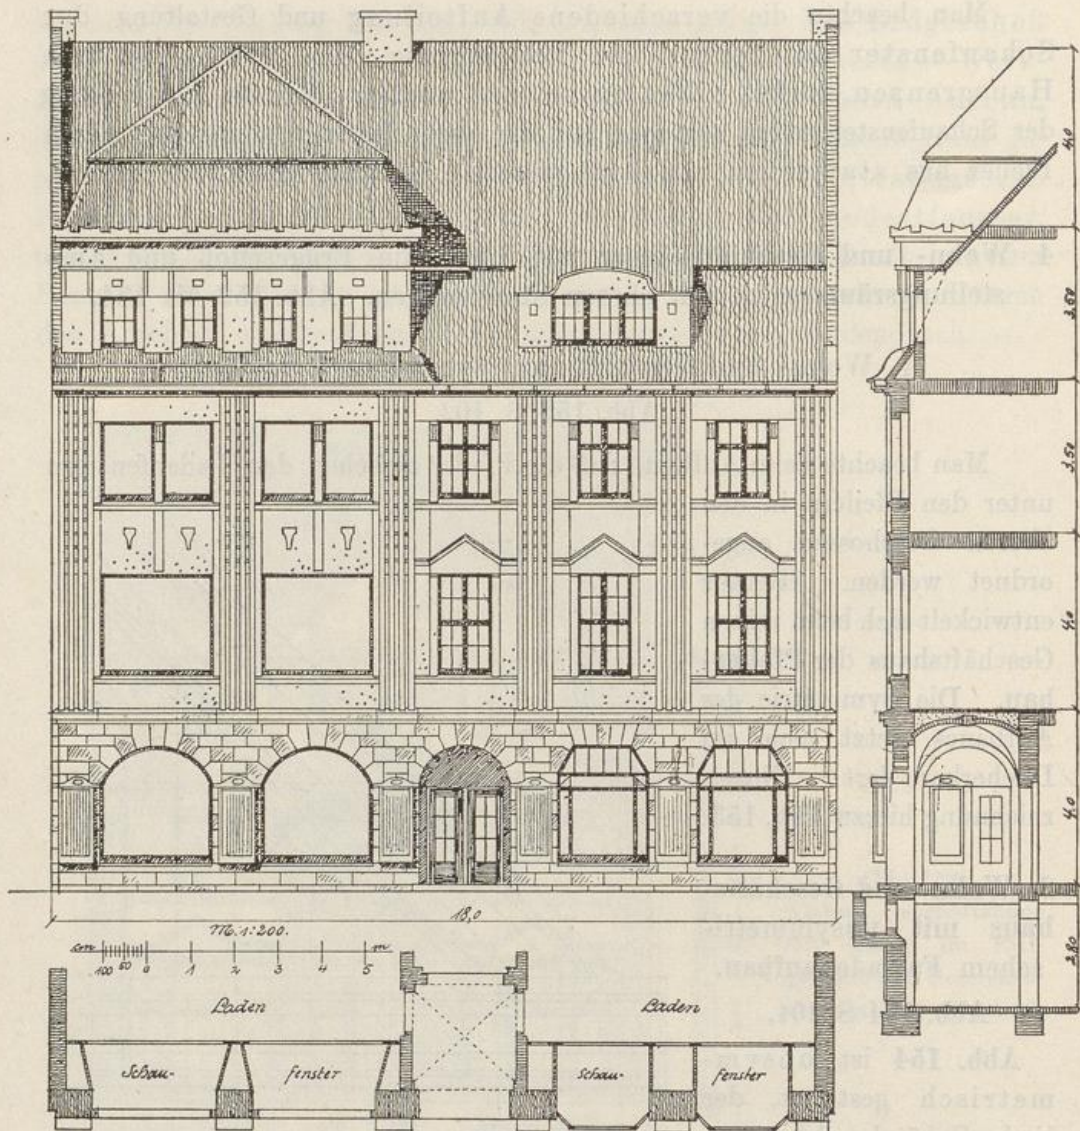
Wohn- und Geschäftshaus mit unsymmetrischem Fassadenaufbau.
